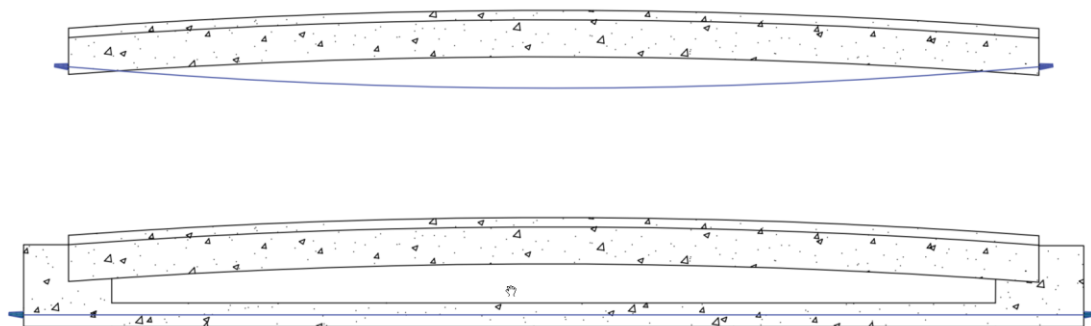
Esquemas conceptuais das vigas T com traçado dos cabos de pré-esforço exteriores à viga.
